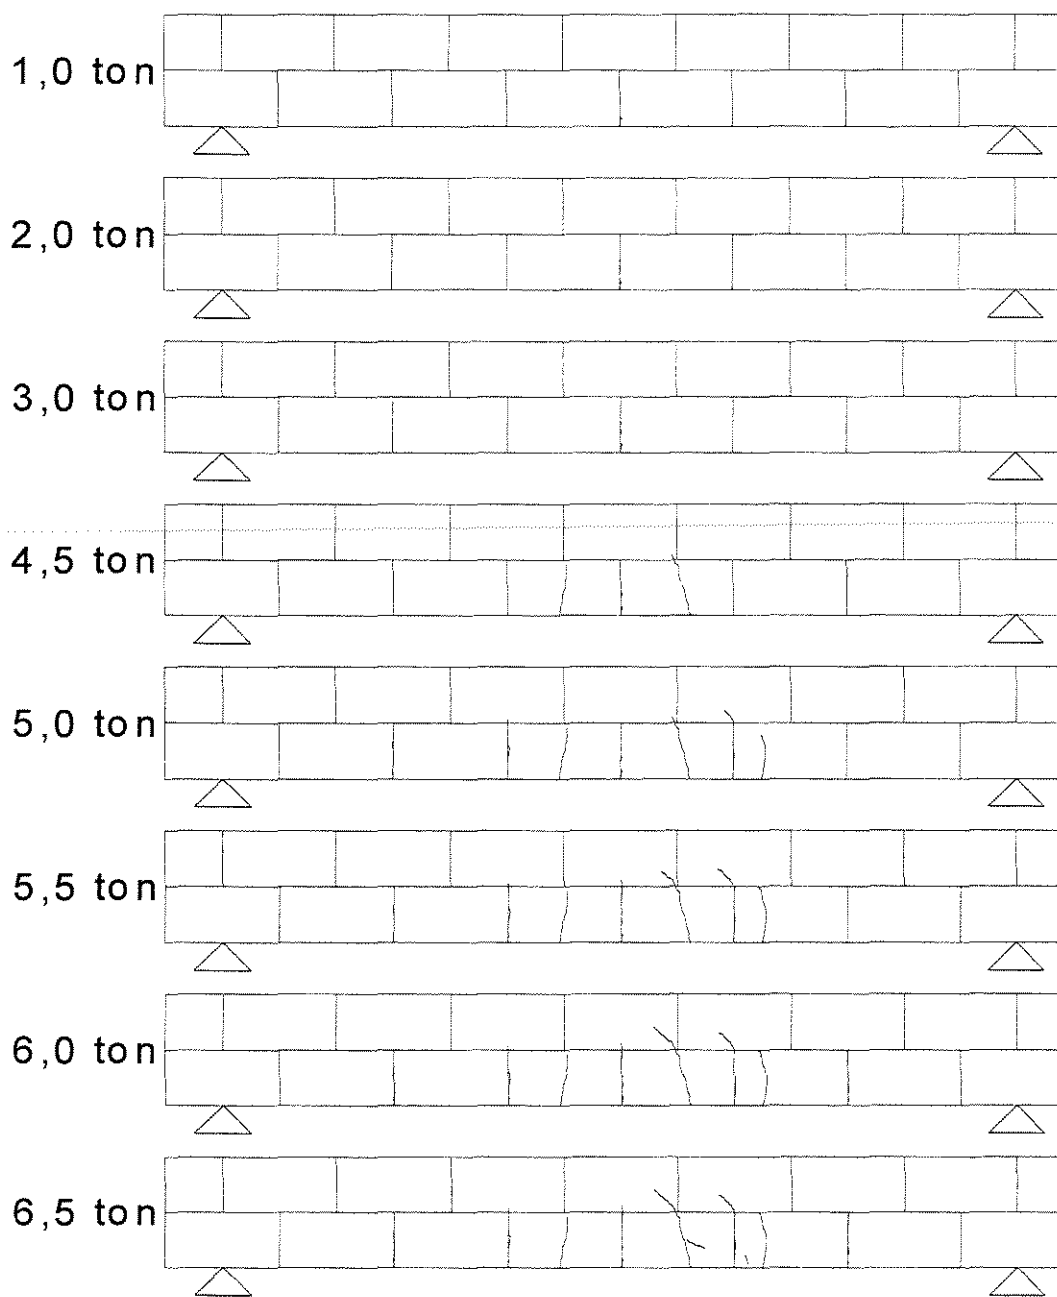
FISSURAS VIGA 2BL-CIS
